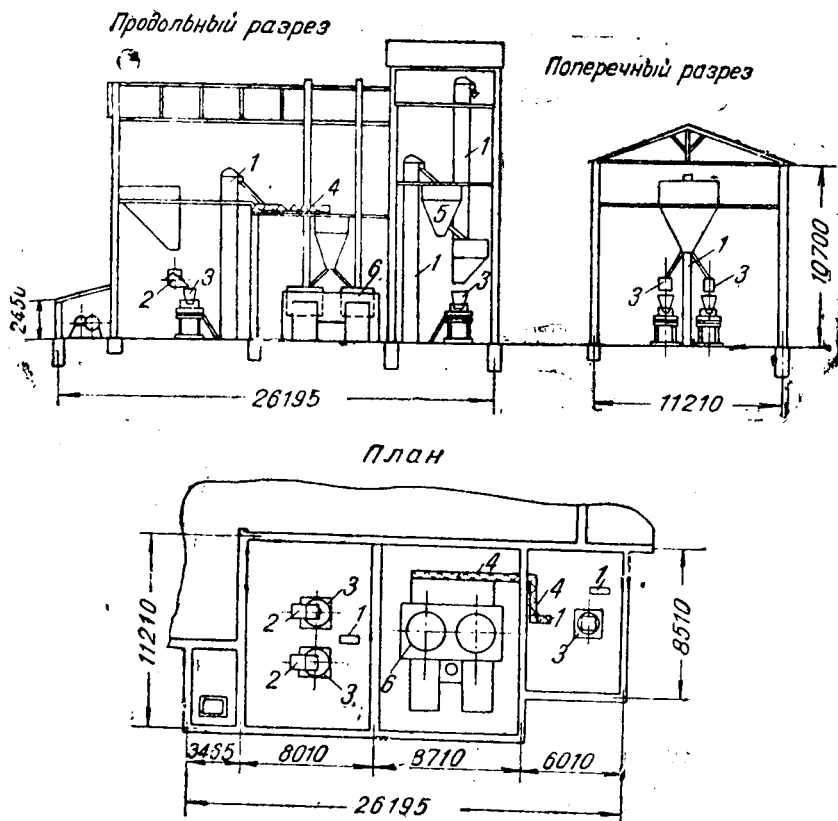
Схема завода штукатурного гипса с варочными котлами: 1—элеватор, 2—трясковый питатель, 3—жернов, 4—шнеки, 5—сепаратор, 6—варочные котлы
